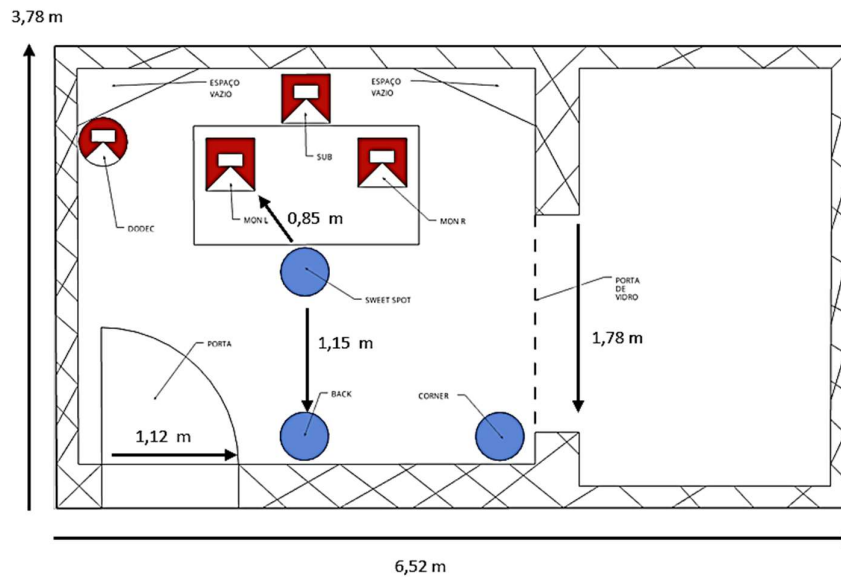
Visão em planta da sala “ARDA – Studio C”
